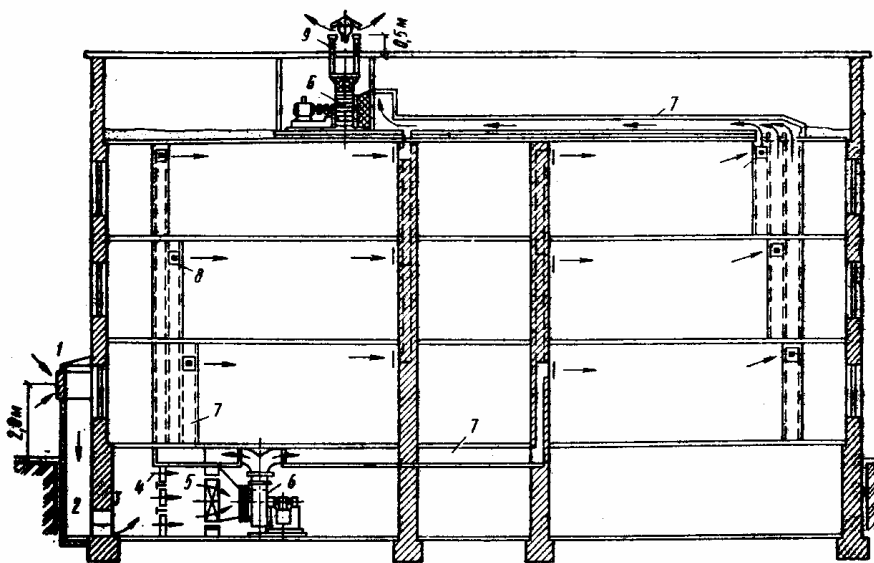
Схема приточно-вытяжной вентиляции общественного здания:
